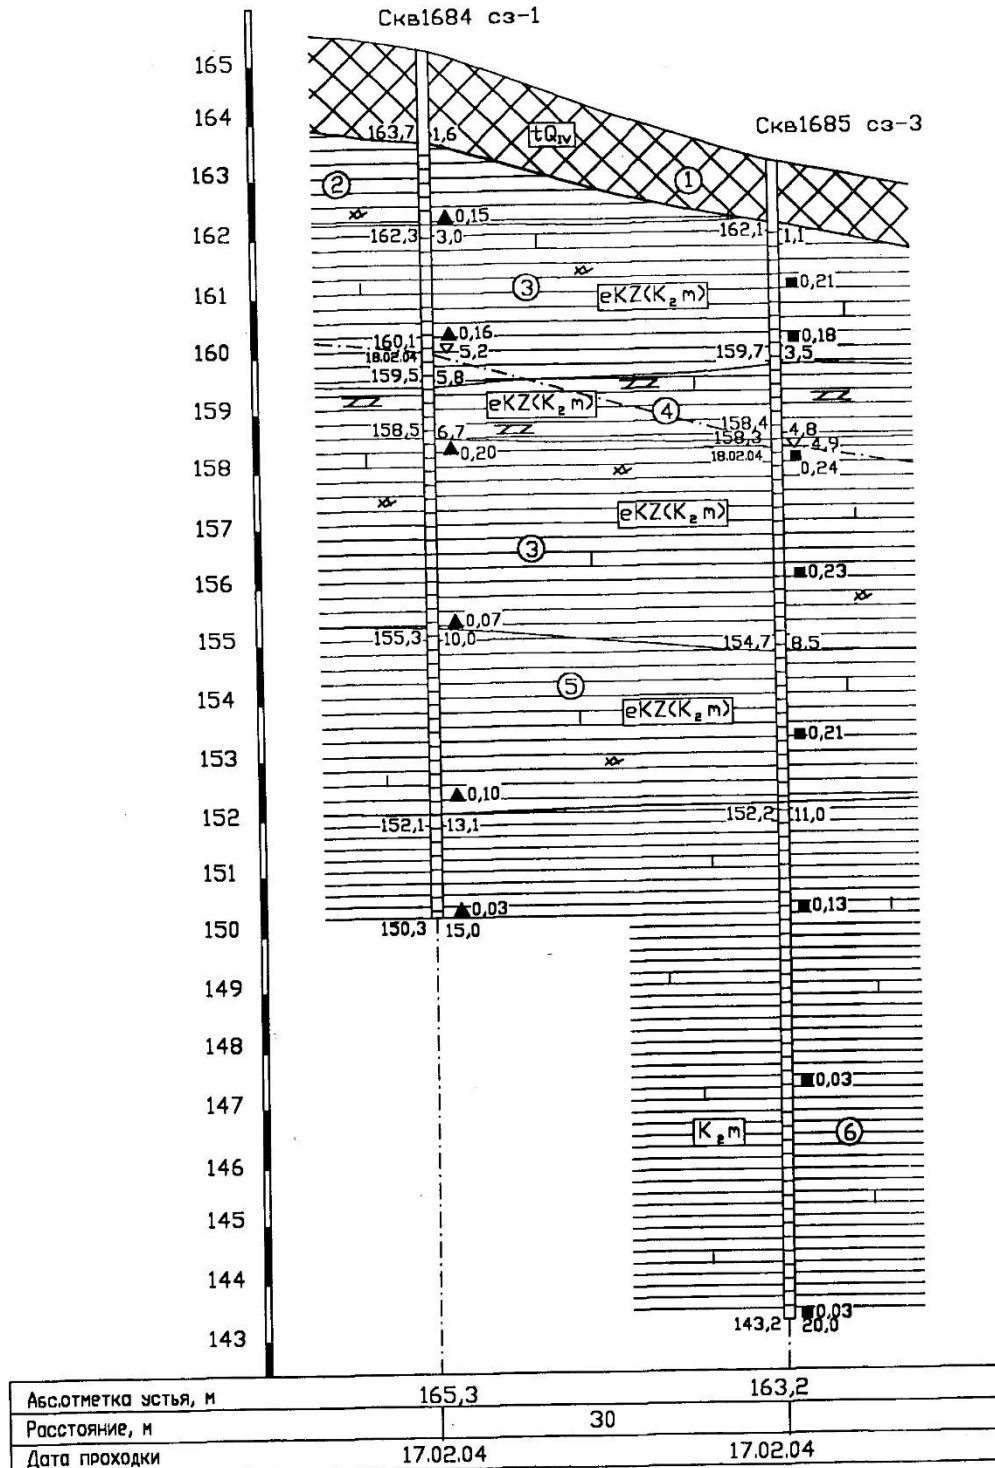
Инженерно-геологический разрез строительной площадки
